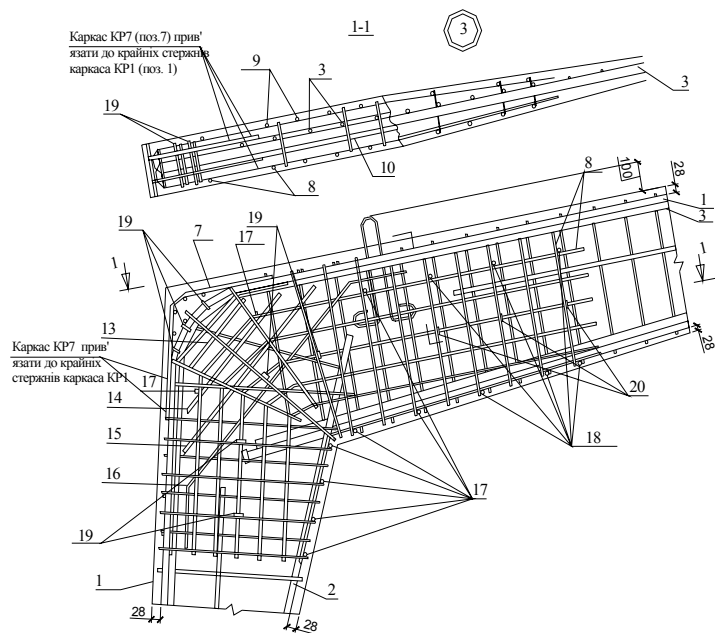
Армування вузла з'єднання ригеля зі стійкою суцільних піврам РЖУ (к. Укрколгоспроект, "КІБІ")
